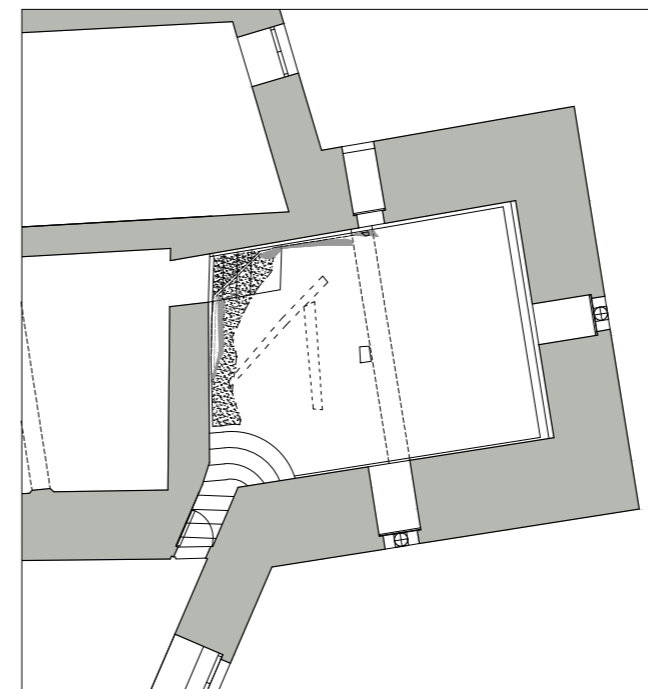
Planta de la cámara mayor después de la restauración, con representación de los elementos descubiertos: escalera en el ángulo, canalizaciones y huellas en el pavimento. (MJB 2016).
